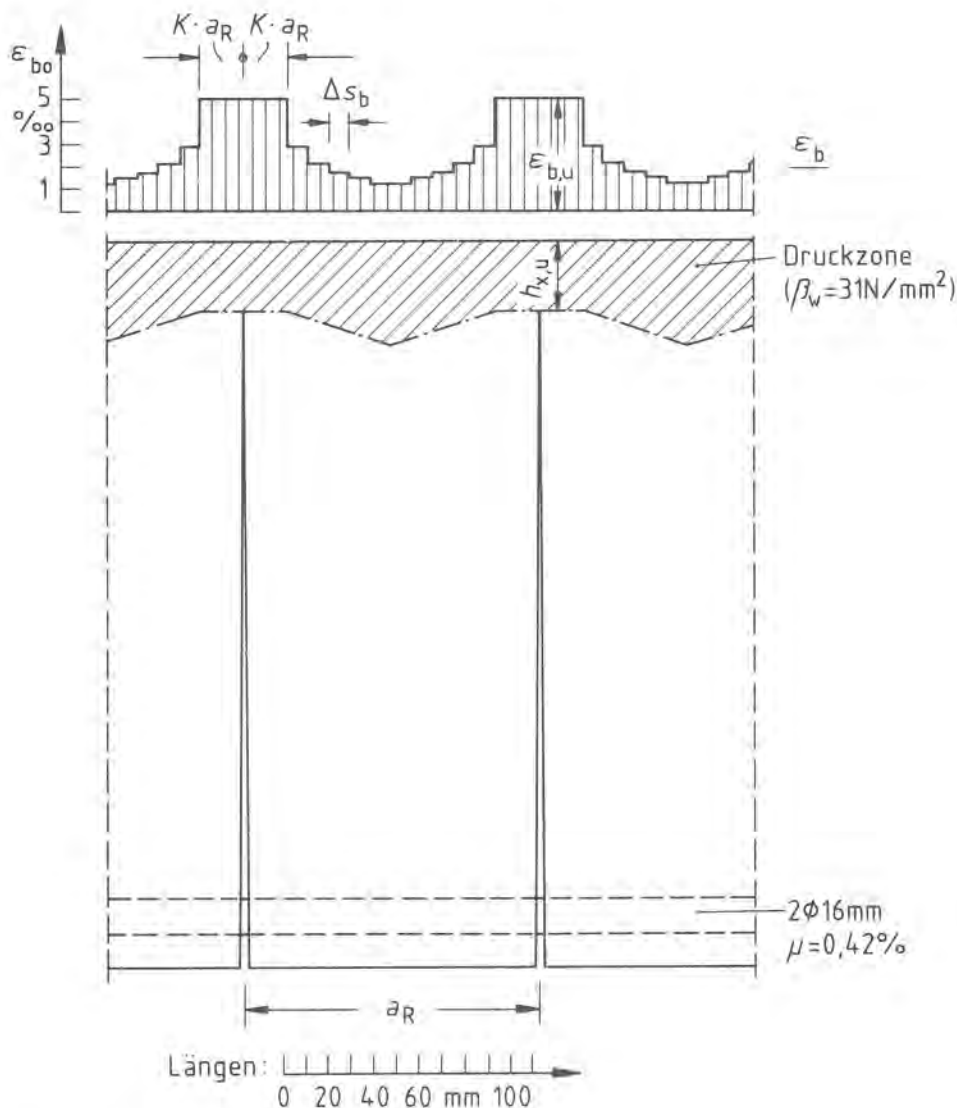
Berechnete Betonstauchungen sowie Verlauf der Biegedruckzone in einem 320 mm hohen und 320 mm breiten Stahlbetonbalken kurz vor dem Versagen des Balkens
